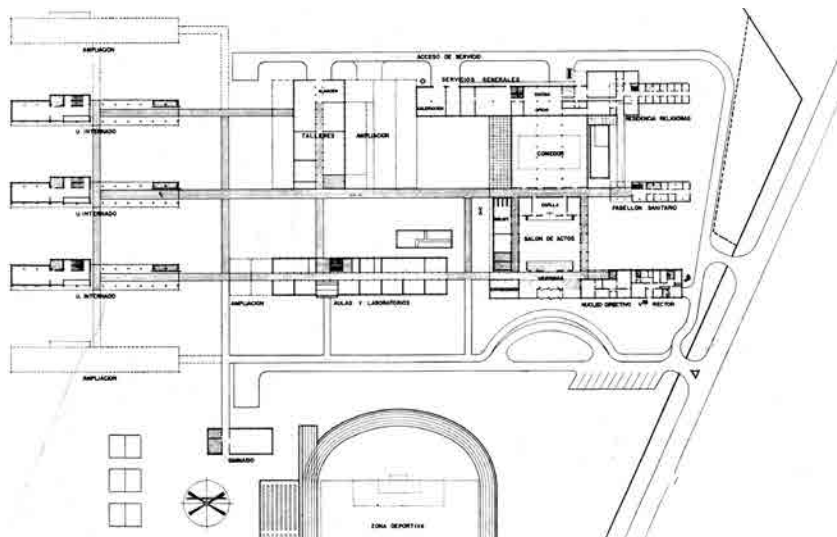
Segundo premio. Planta general de ordenación del conjunto.
